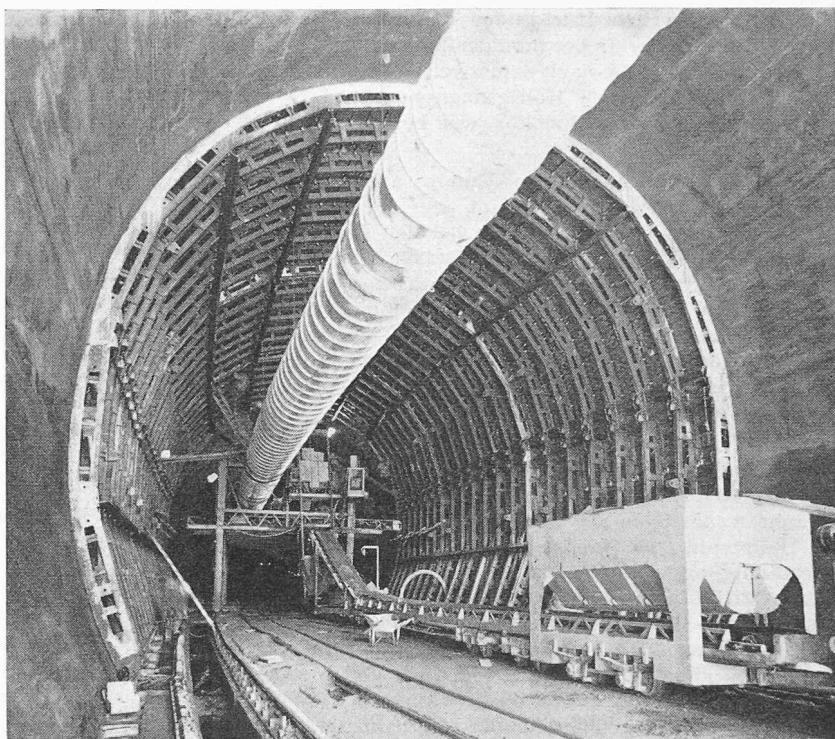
Betonieranlage mit Taschenwagen und Entnahmeband
